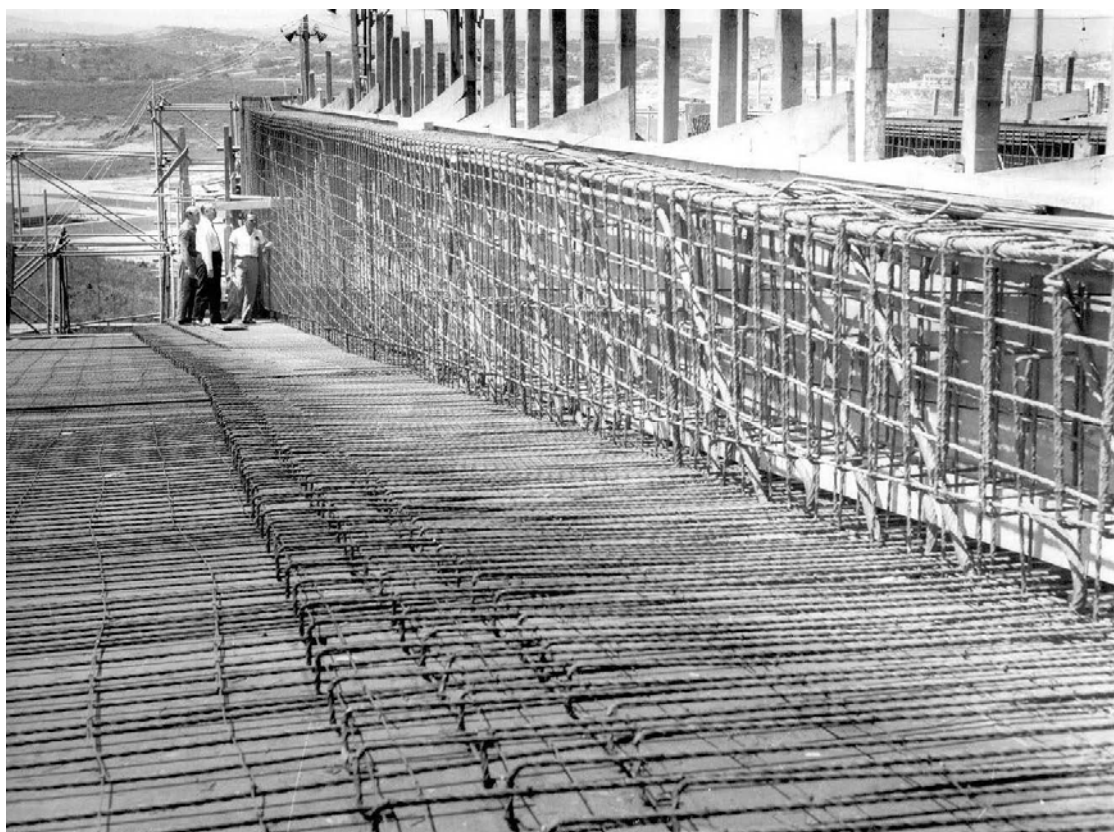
Armação de uma viga e laje da cobertura sendo vistoriadas por engenheiros
